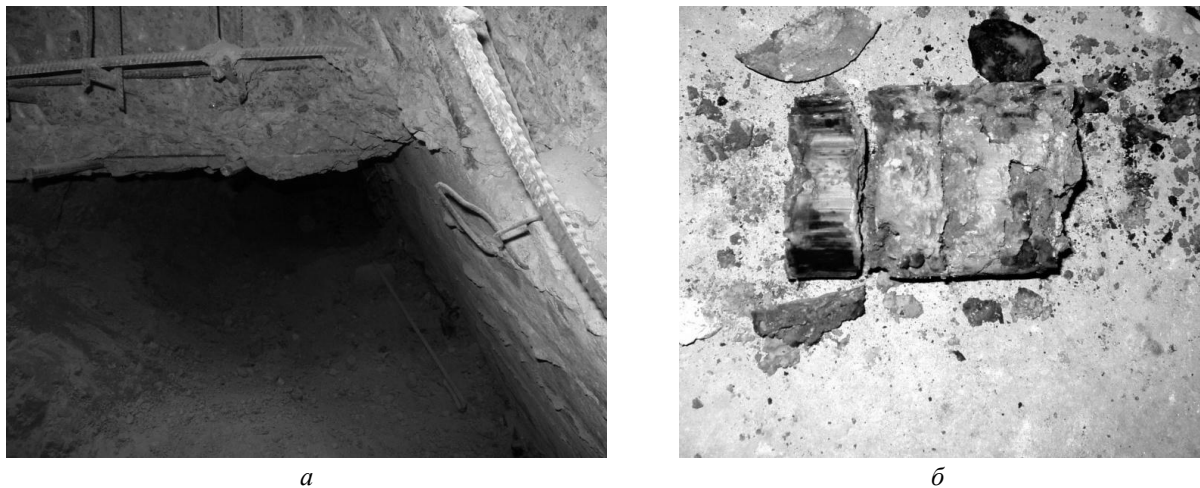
Техногенна пневматична ерозія і схема пошкодження фундаменту вентиляційної установки ВЦД-47У внаслідок техногенної ерозії ґрунтової основи: а – каверна під підшовою фундаменту (п. б на рис. 2, а); б – керн зразка ґрунту в зоні висихання і розтріскування, взятий з відм. -4.0 м (п.1 на рис. 2, а)
